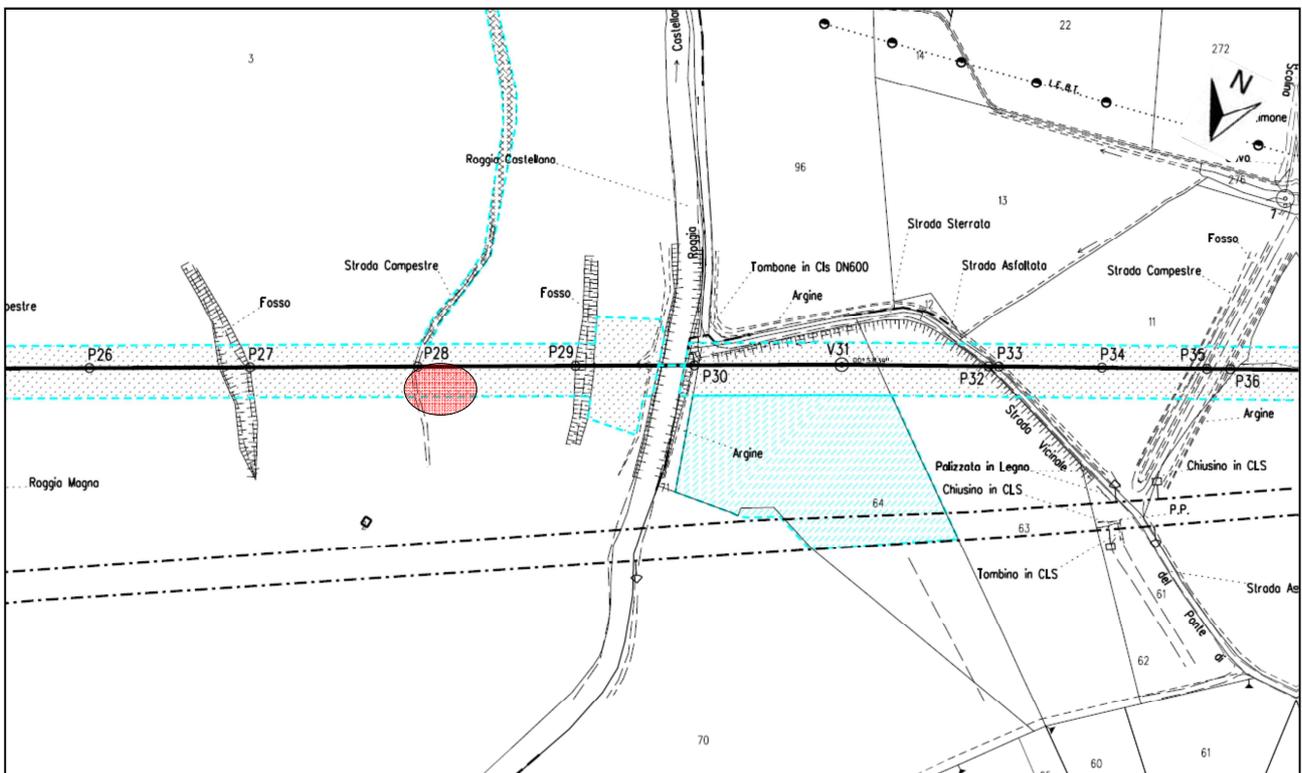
Localizzazione Area Test VEP 05 VG su planimetria catastale
